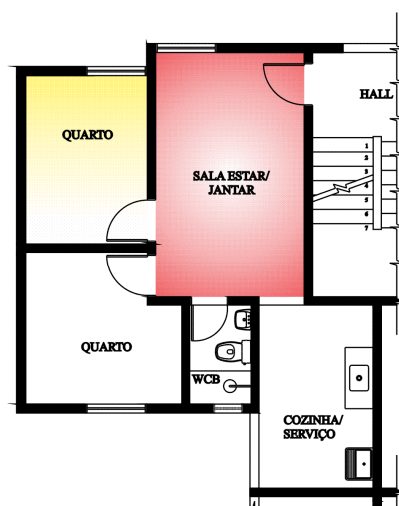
Planta Baixa Pav. Tipo do Residencial Morada das Artes (sem escala)
